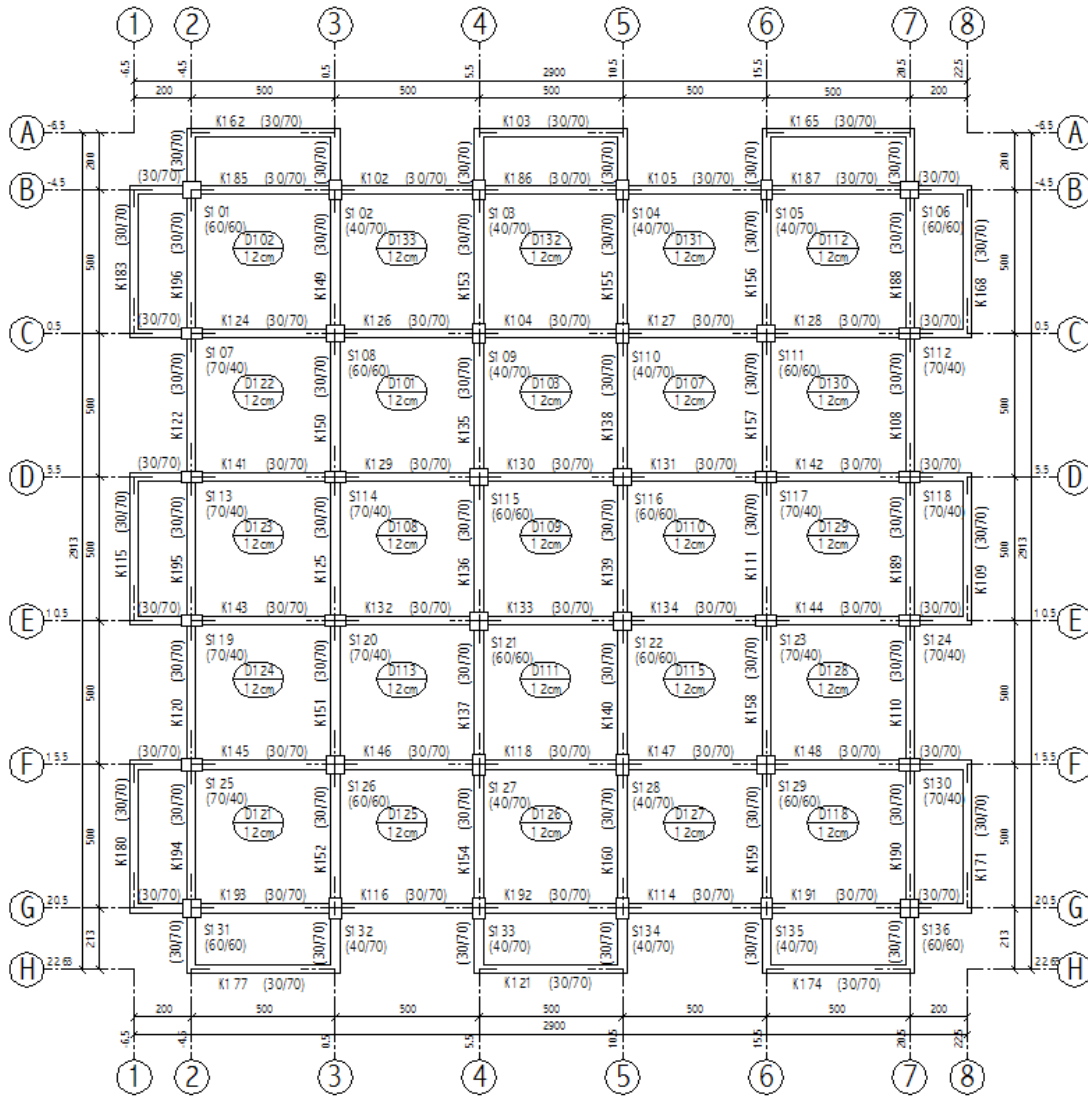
Bina B 10 katlı basık kirişli plan bilgisi
